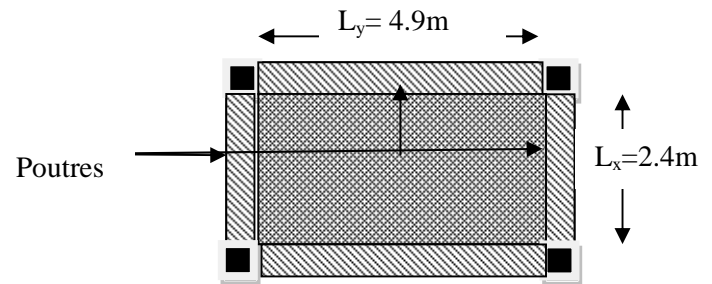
Schéma de dalle sur 4 appuis panneau 1.
